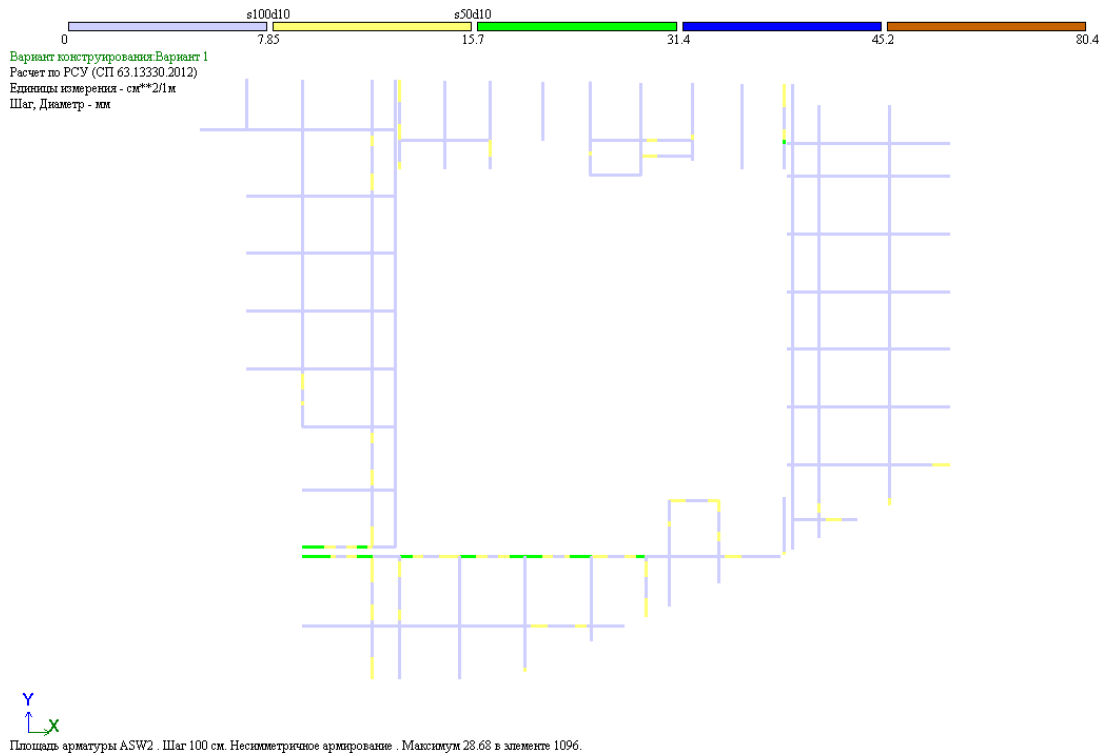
Площадь арматуры ASW2 в балках покрытия
